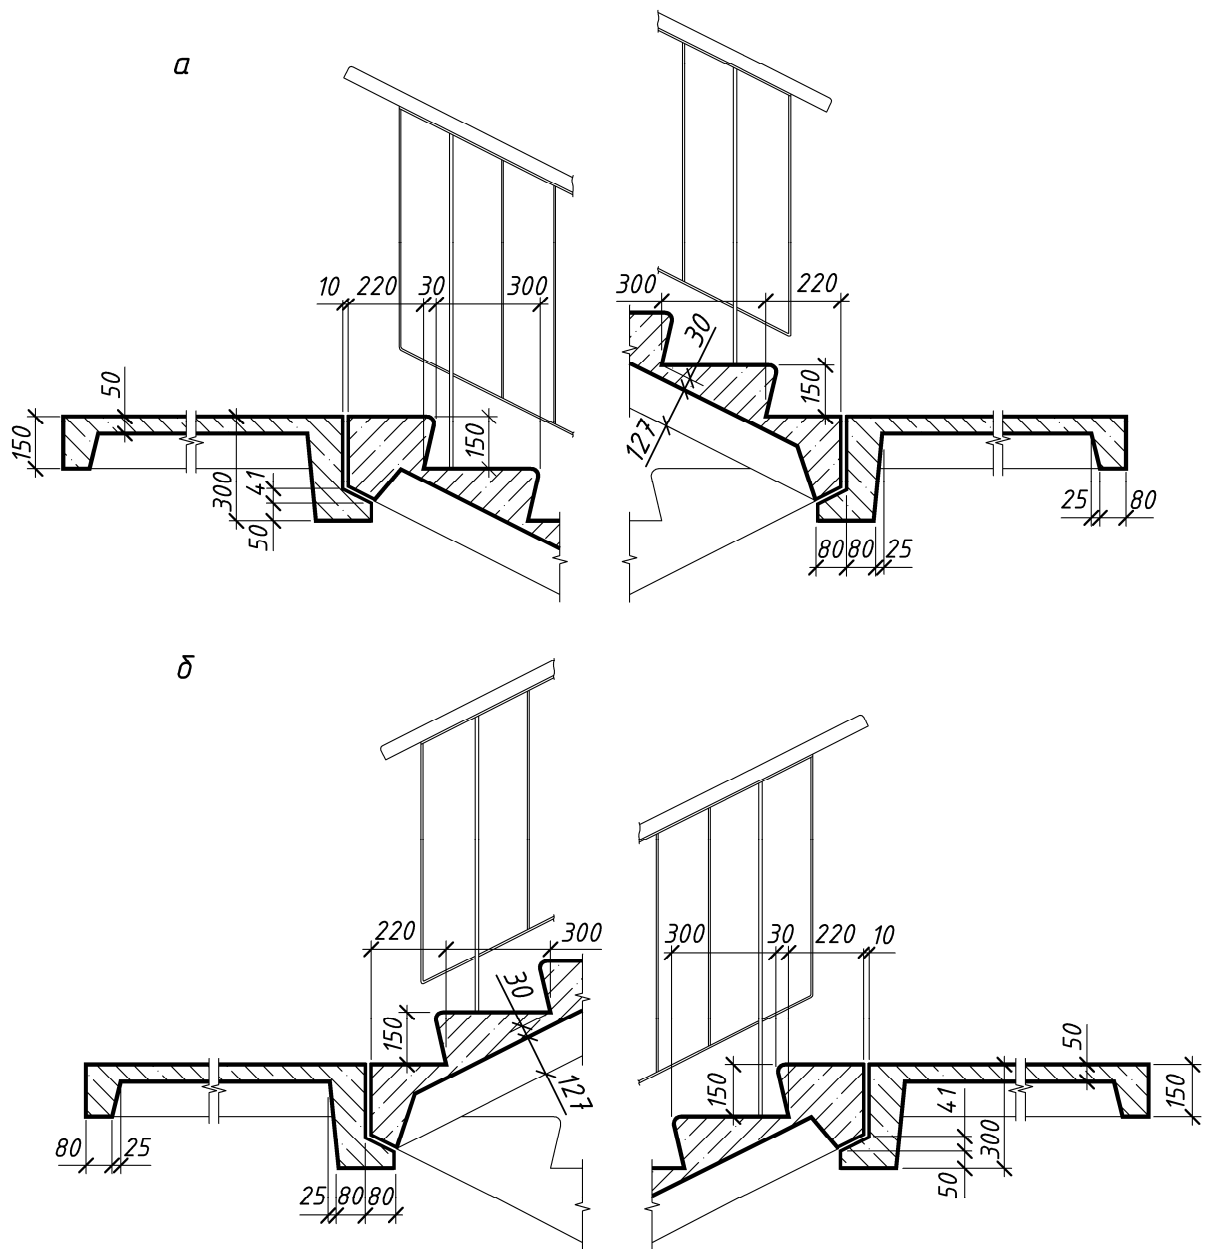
Узлы сопряжения лестничного марша с лестничными площадками
